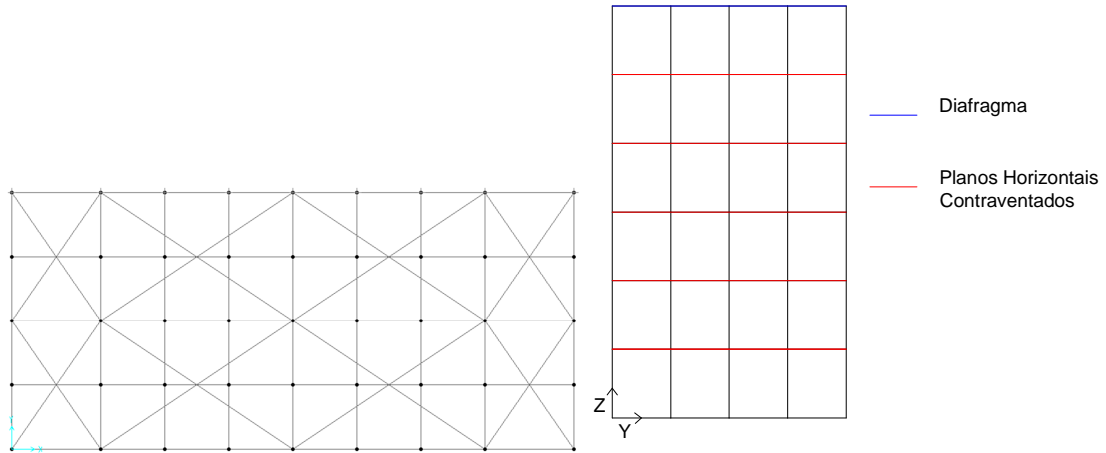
Configuração dos Planos de Contraventamento Horizontal Com Elementos de Contraventamento Grandes
